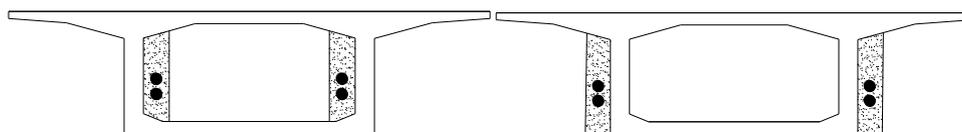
腹板加厚、张拉体内预应力位置示意
